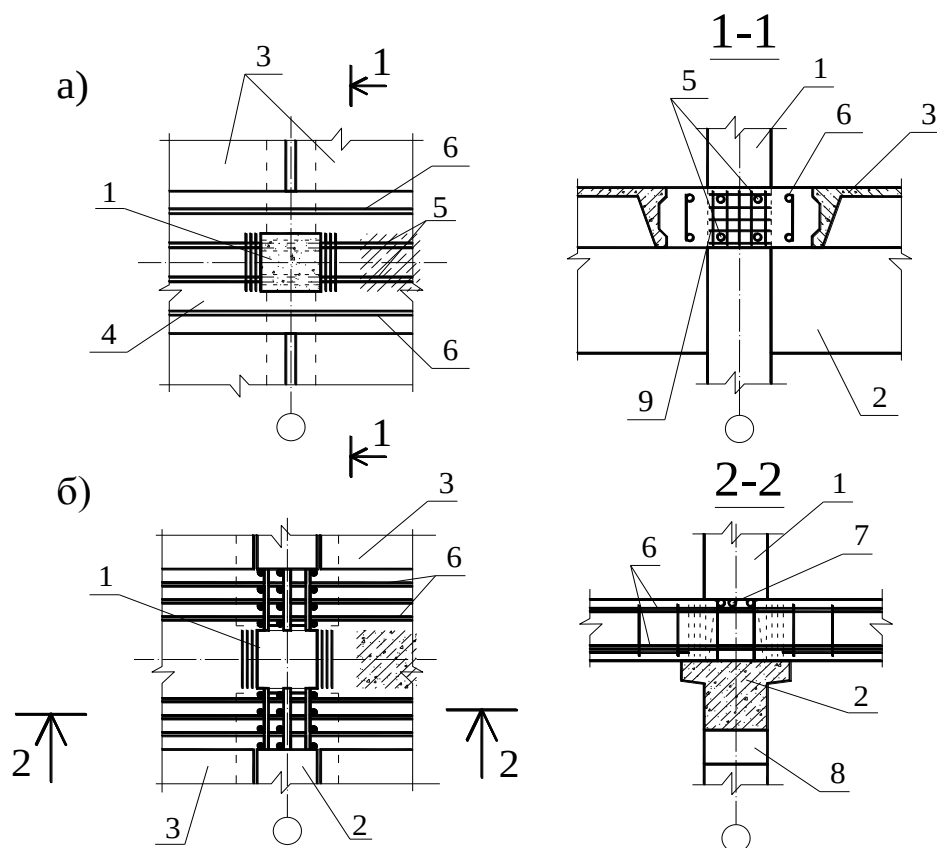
Узел сопряжение продольного ригеля с колонной при бесконсольном (а) и консольном (б) опирании поперечных ригелей:
